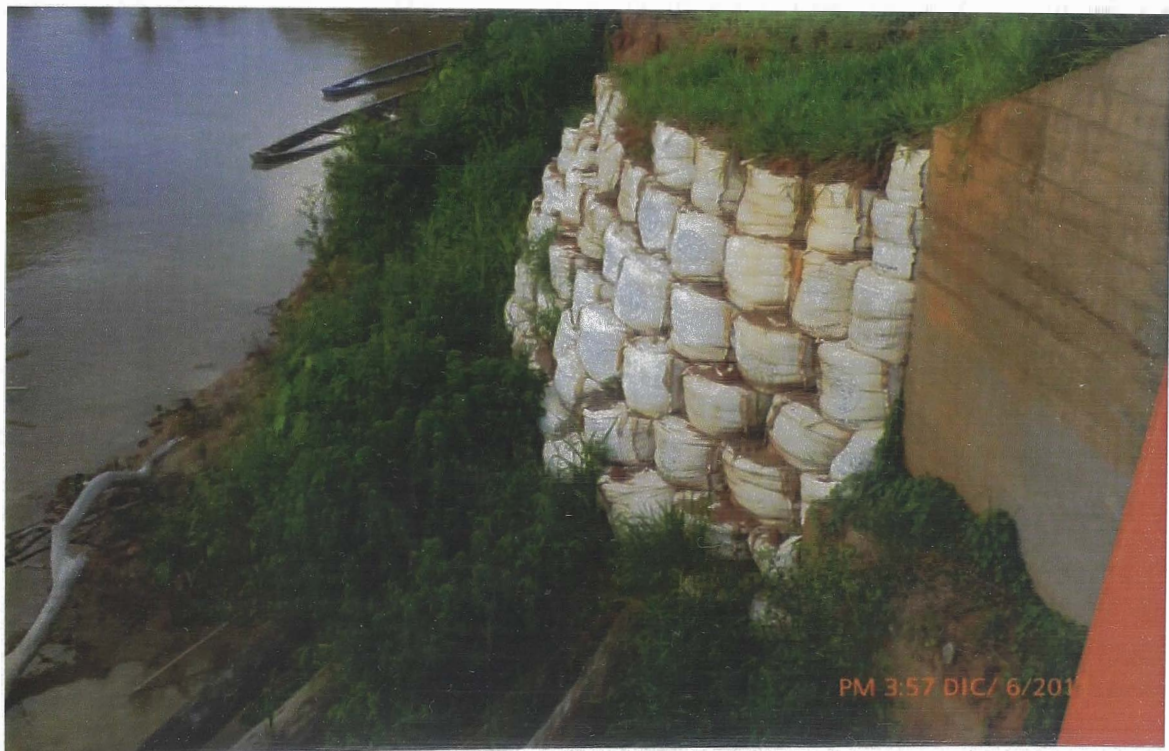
Geobolsas usadas para proteger el estribo izquierdo del puente Mavila.
